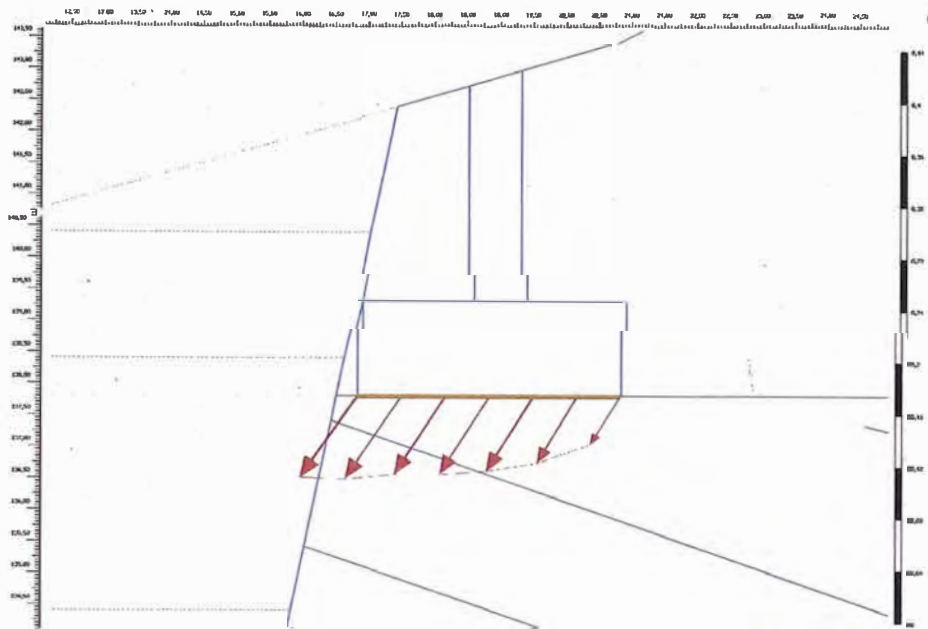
Distribución de los desplazamientos bajo la zapata del puente.
